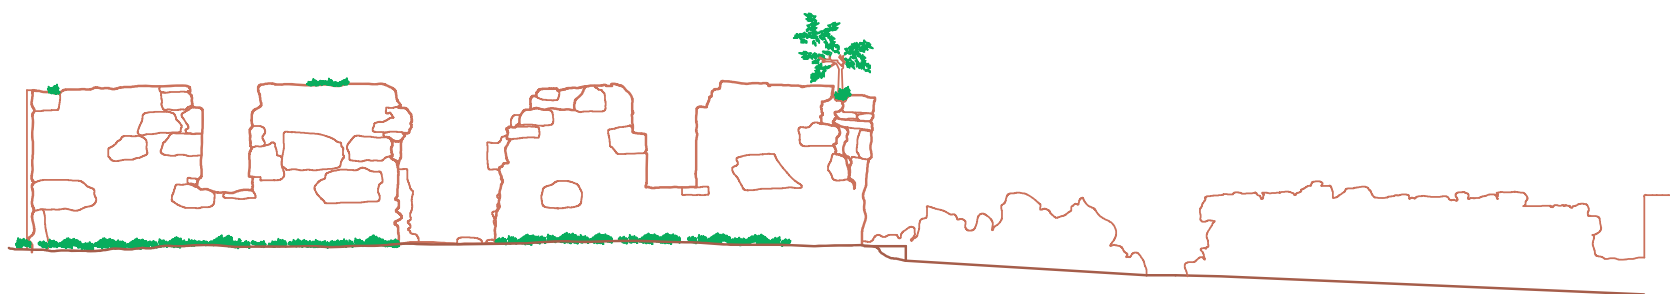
Fachada Principal (Desenho final: Arquiteto Pedro Israel de Paiva)
